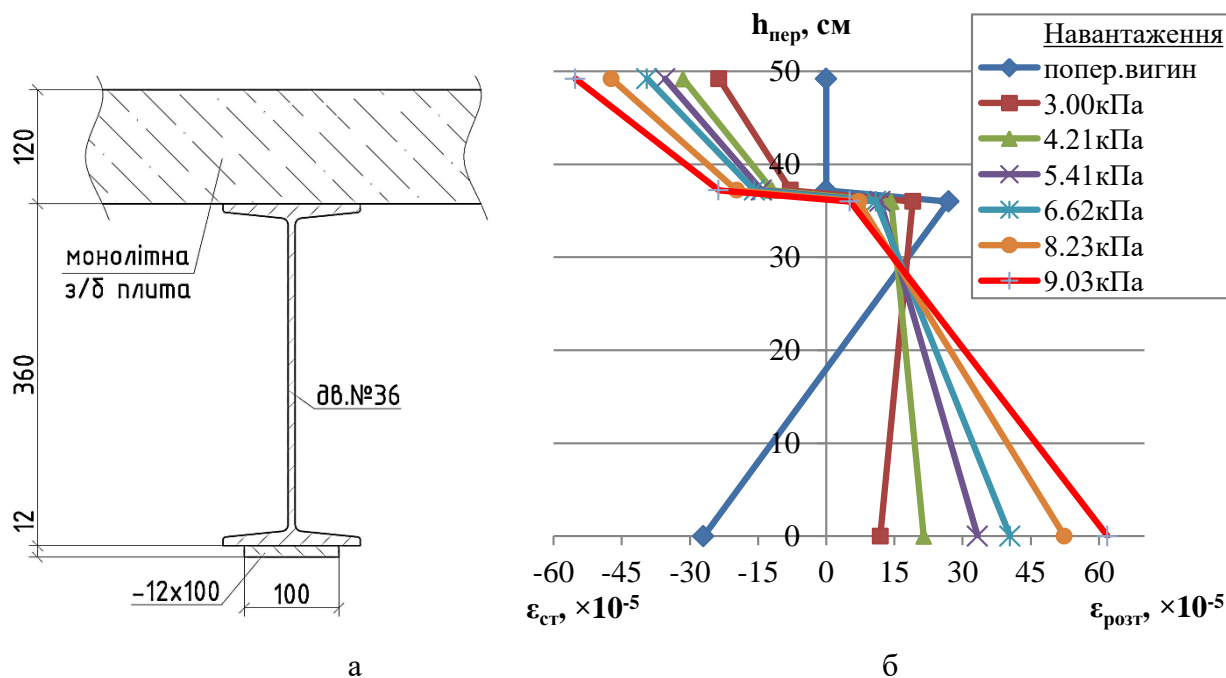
Зміна відносних деформацій по висоті перерізу балки експериментально випробуваного СЗБ перекриття на кожному етапі навантаження:
